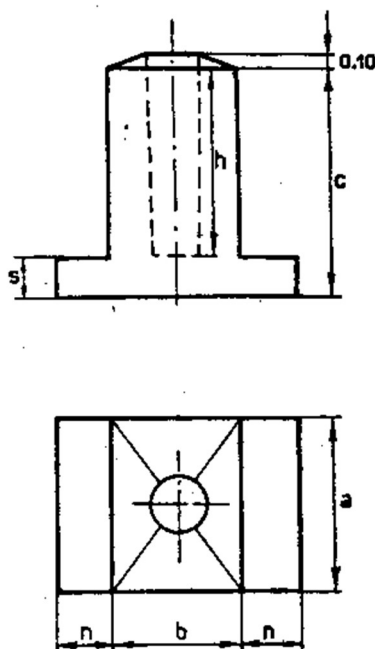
Blocco a pilastrino con soletta non armata, su rilevati poco consistenti
